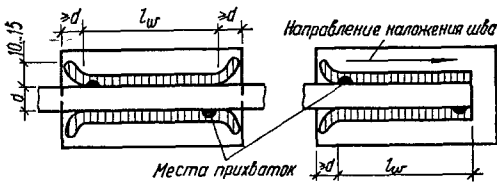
Ручная дуговая сварка внахлестку фланговыми швами.
